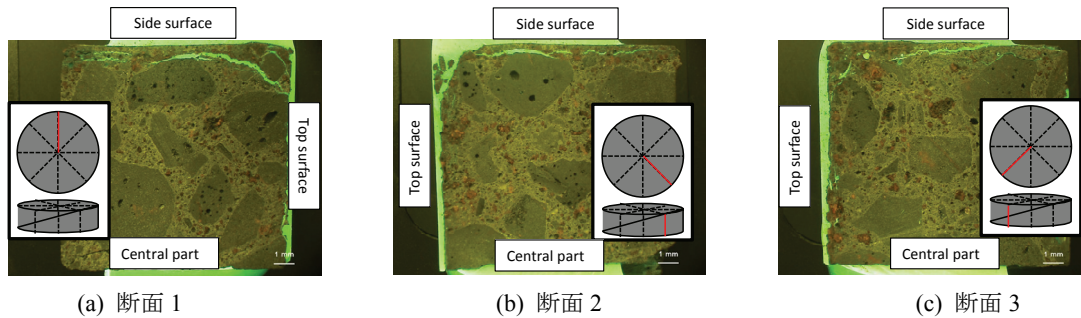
コンクリート円柱供試体の微細ひび割れ発生状況（HWC3.8，海水シャワー暴露場）
